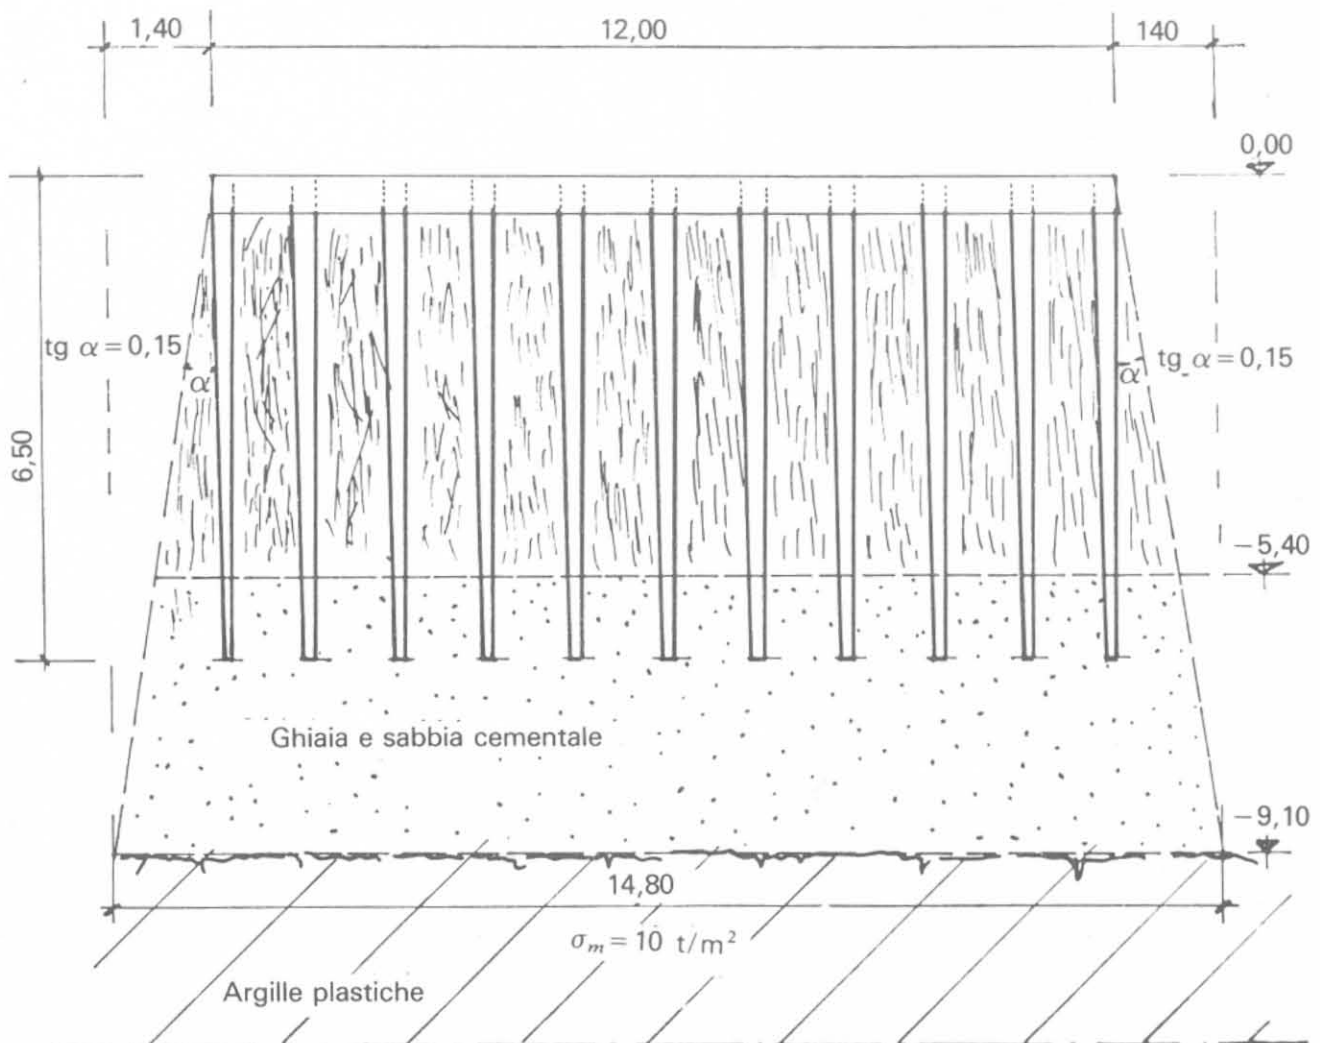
Fondazioni con diaframma di pali trivellati e pali prefabbricati portanti (Fondacem); (sotto) schema della fondazione.
